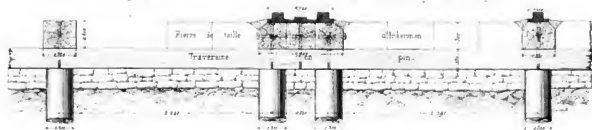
Construction de l'avant-cale (dans le mur de face) sur des poutres, à 0,75 p. r
